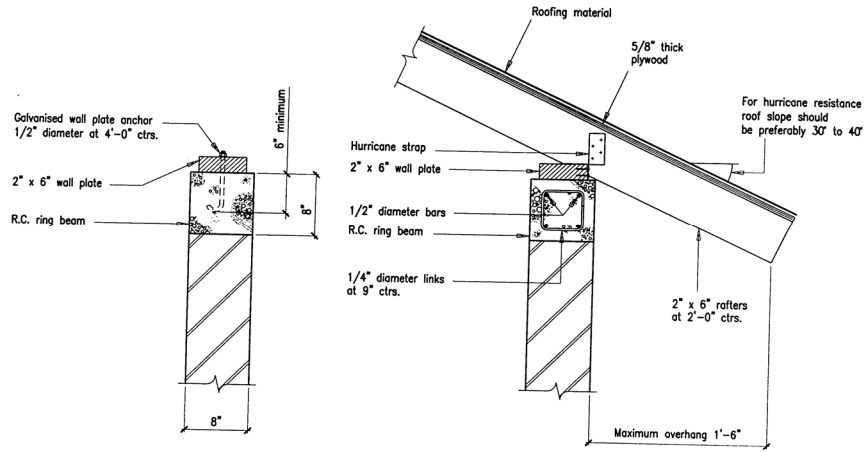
Possibilités ancrage ferme / poutre en béton armé
